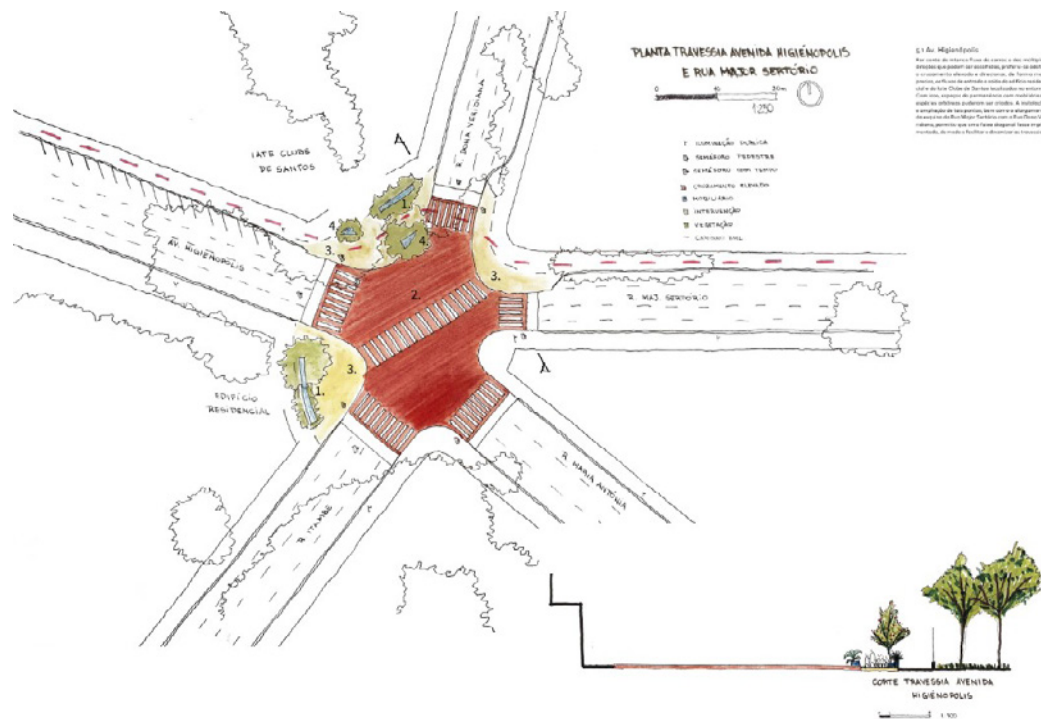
Planta e corte da travessia Av. Higienópolis e Rua Major Sertório. Fonte: Elaborado pela equipe, 2023.
